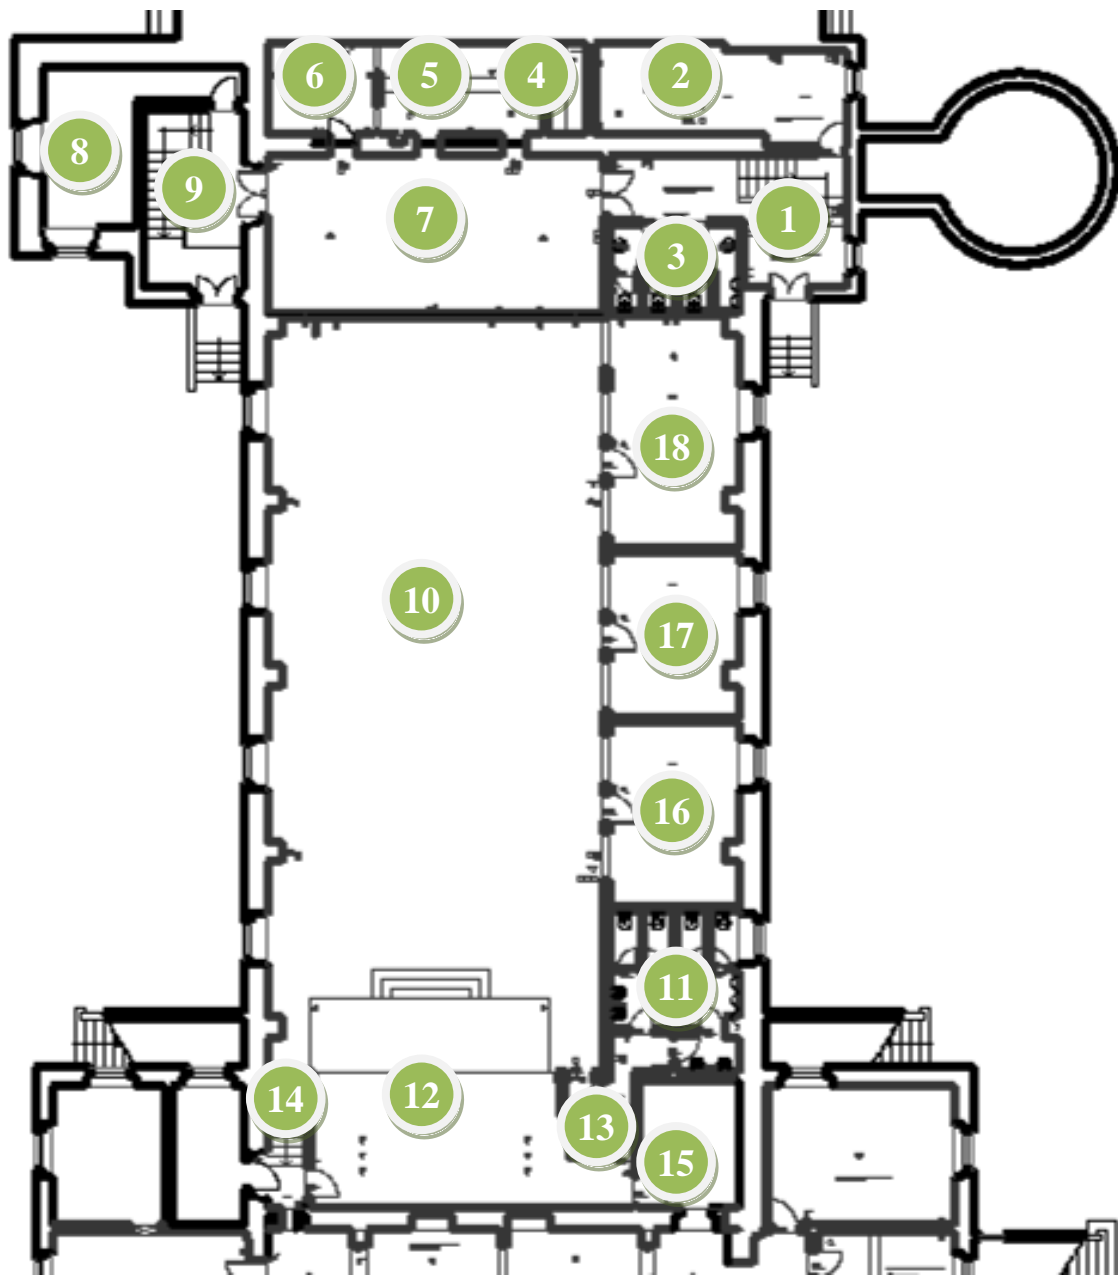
Planta actualizada da zona de intervenção: situação actual (sem escala) [4]
